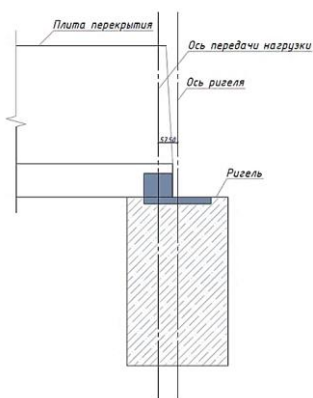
Узел установки плиты перекрытия на прямоугольный ригель
